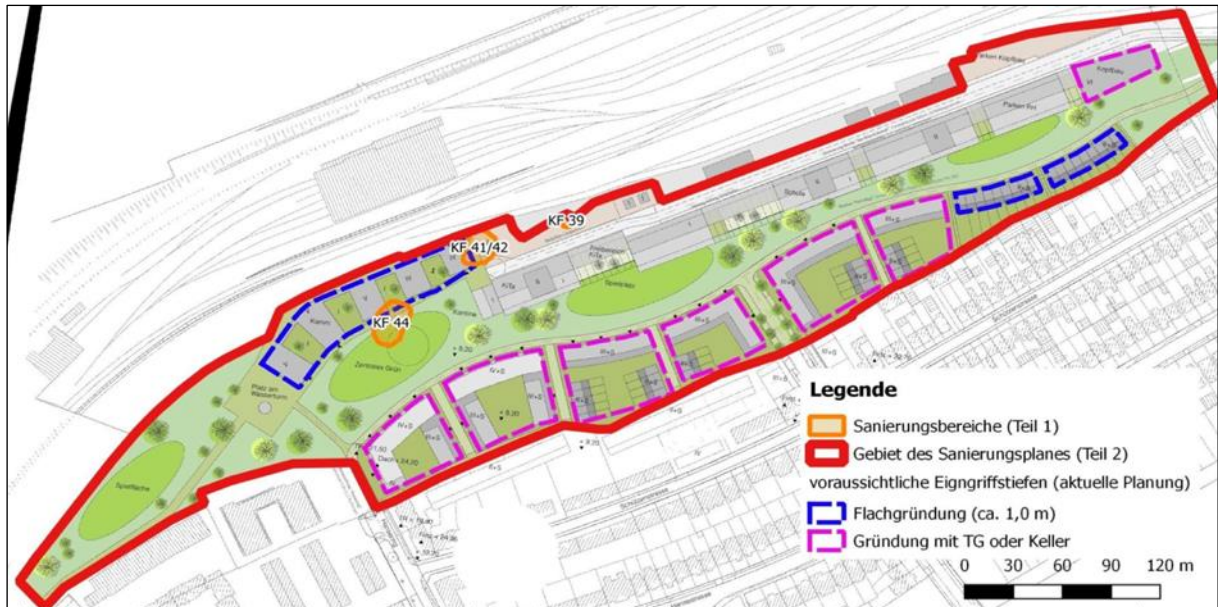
Sanierungsplan mit Sanierungsbereichen (Quelle: M & P 2020)
